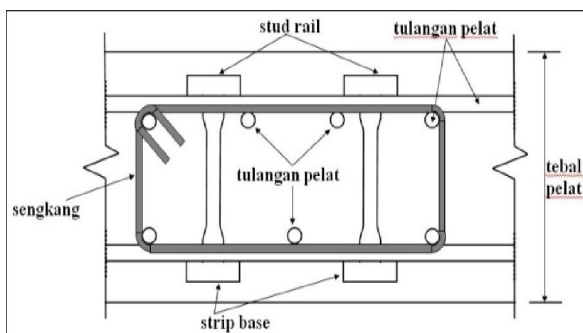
Denah stud rail pada Benda Uji CRT
